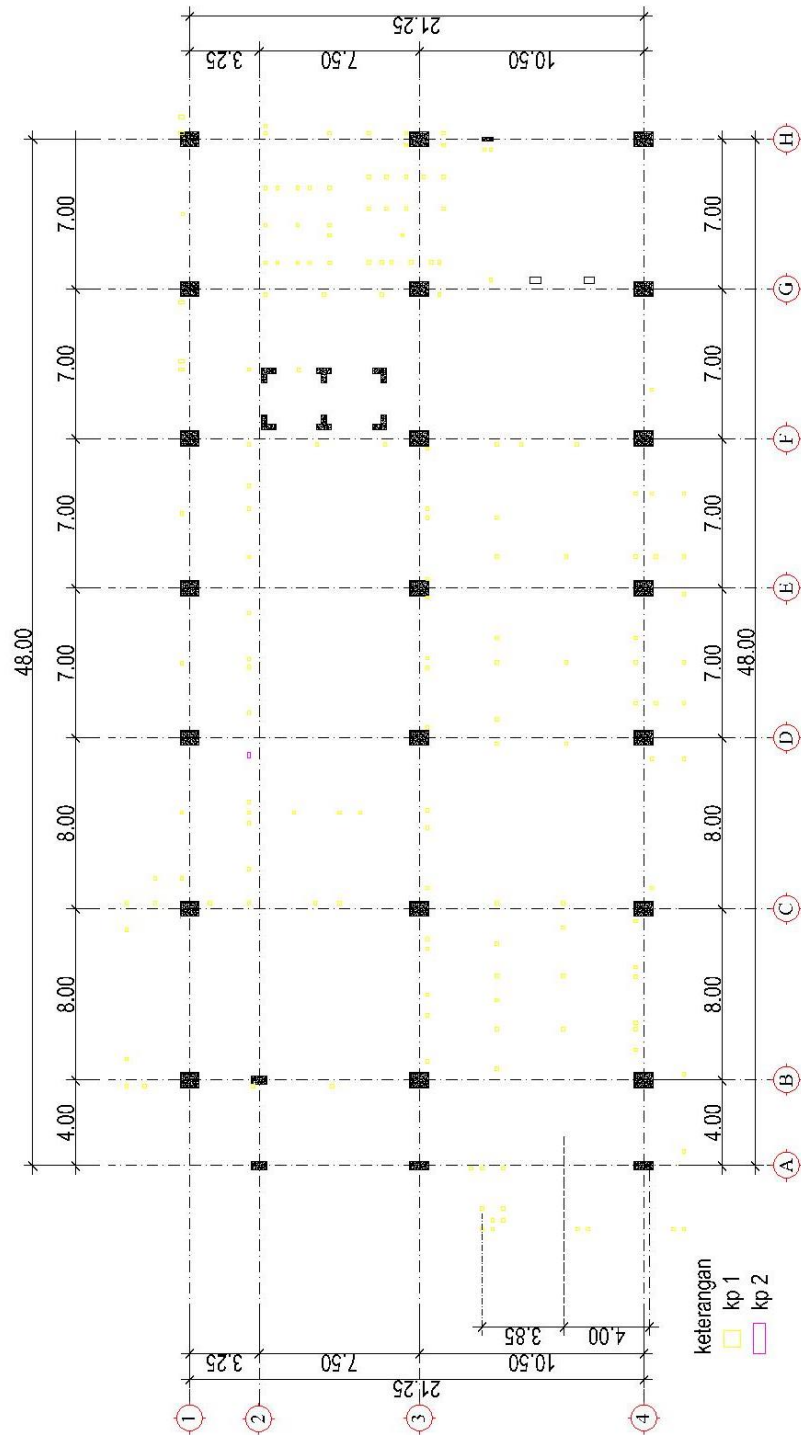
Denah Rencana Kolom Elv. + 9.36
